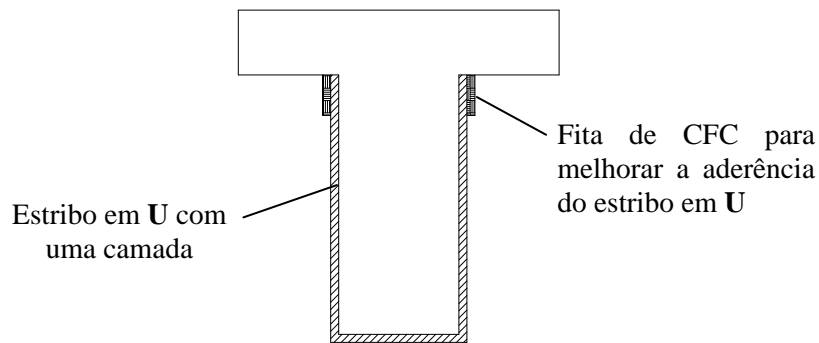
Seção transversal AA' das vigas reforçadas VI-1 e VII-1.
